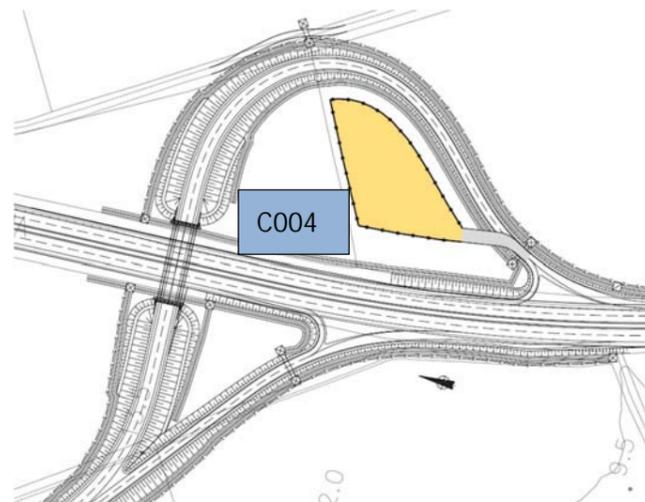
Planimetria con l'area di cantiere CO04 del nuovo svincolo
